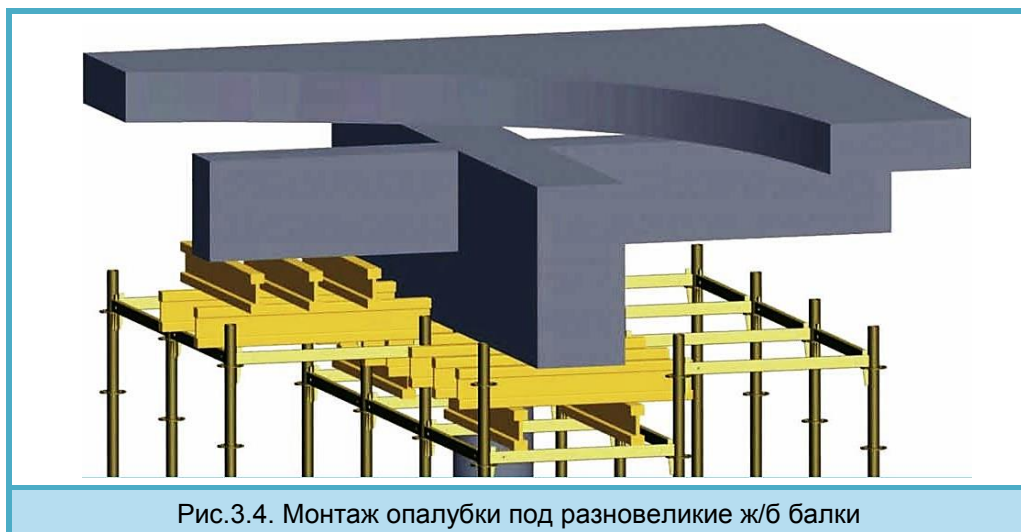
Монтаж опалубки под разновеликие ж/б балки
